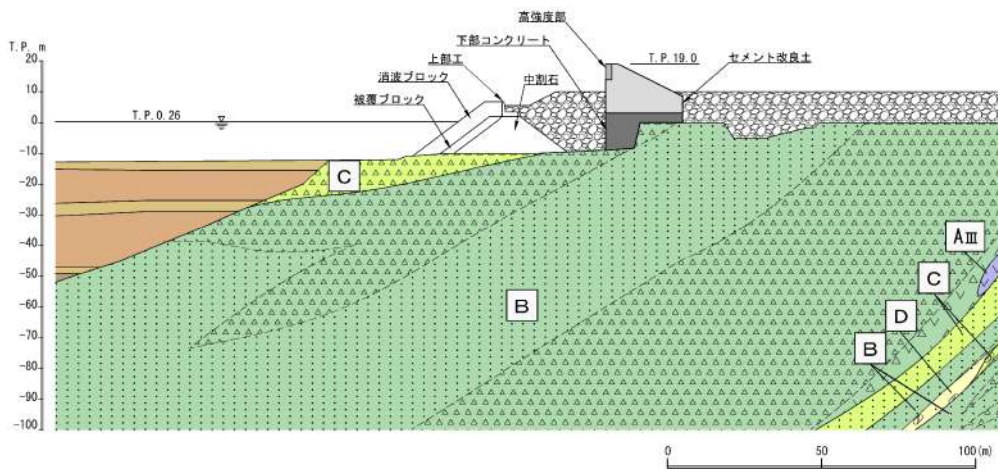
c.b-11 地質断面図 (C-C' 断面)
